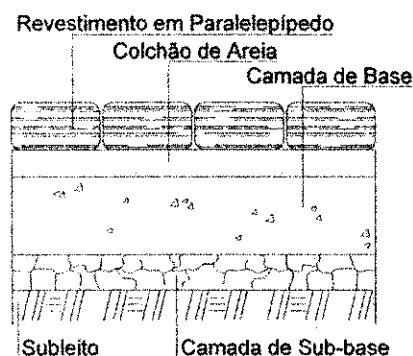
Pavimento com revestimento em paralelepípedo (sem escala).
